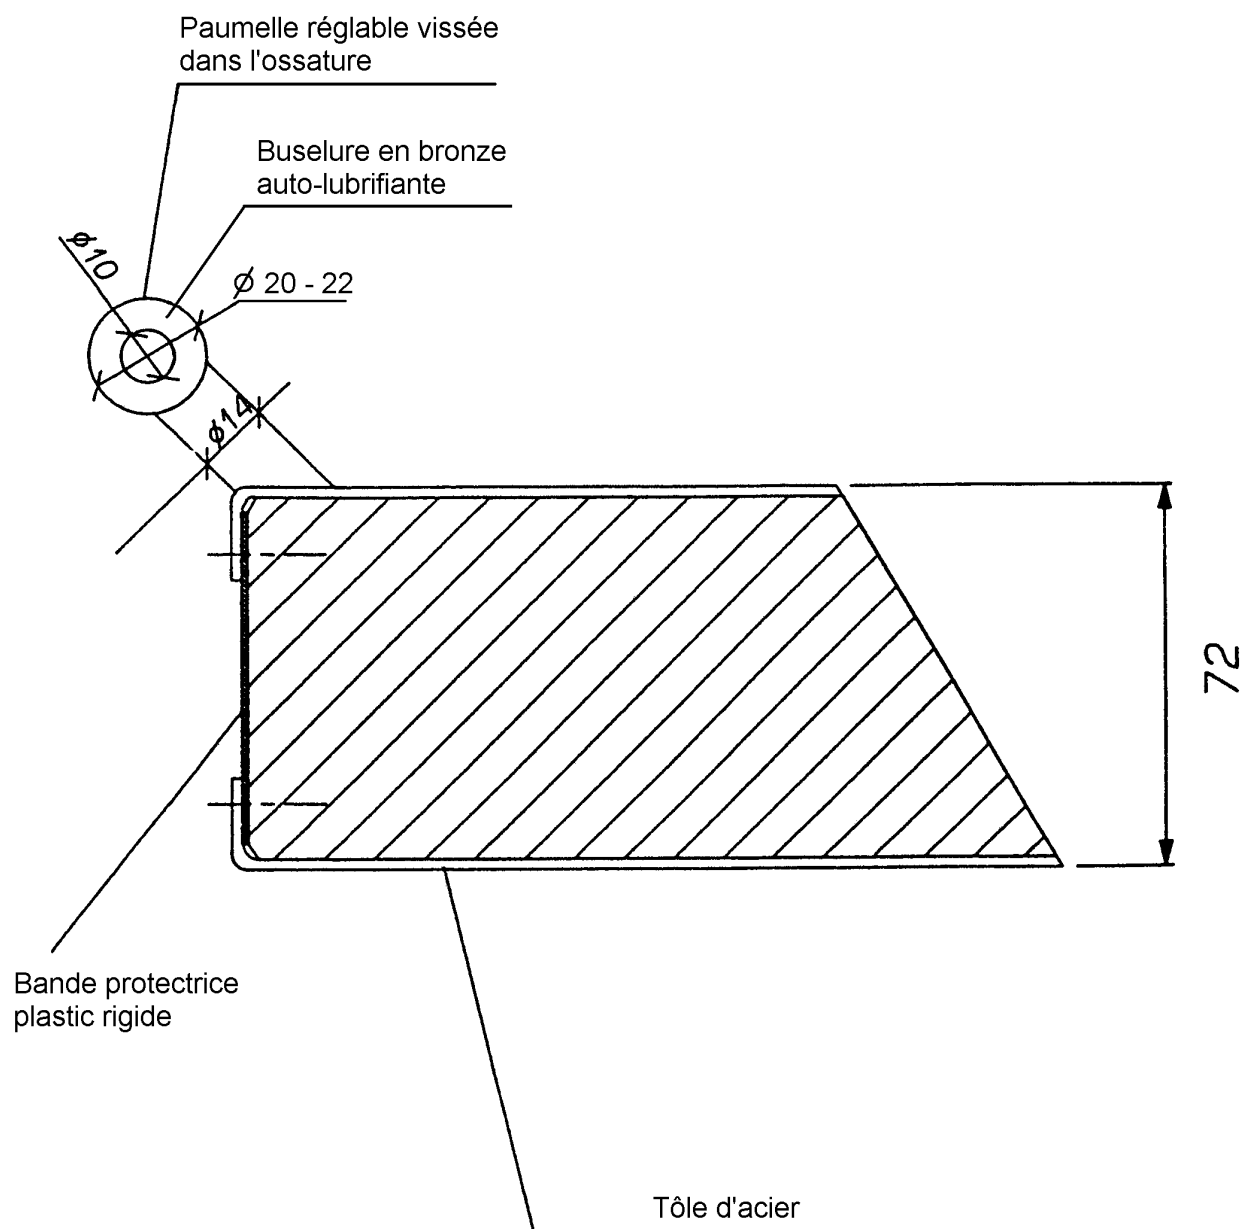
Détail du vantail à l'endroit d'une paumelle
